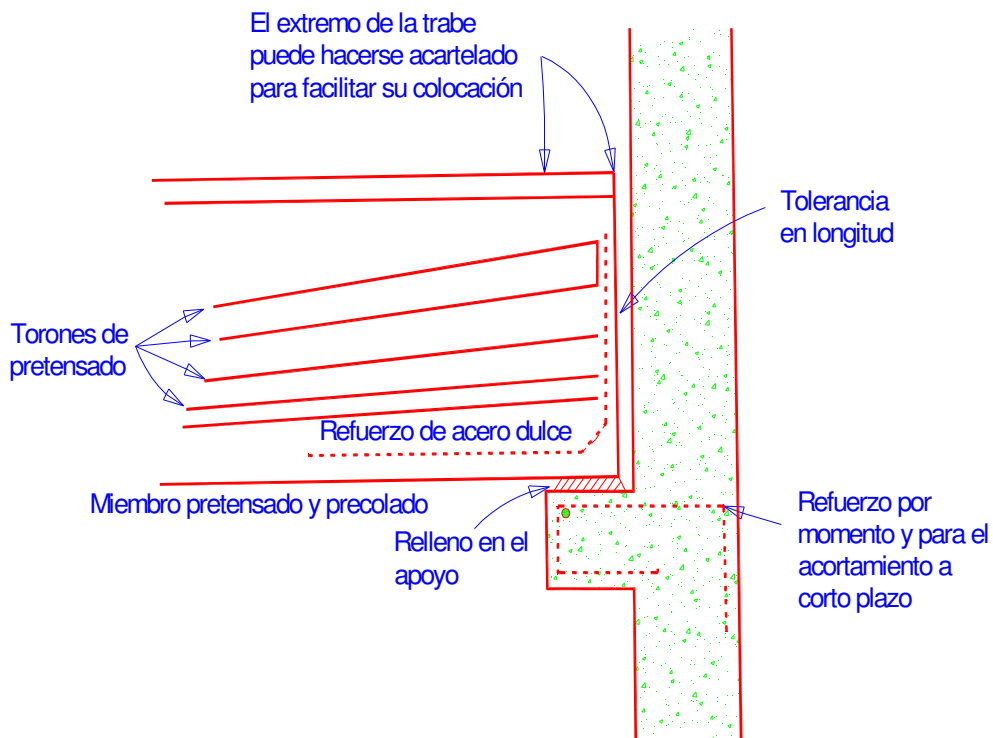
Detalle típico de apoyo; losa o trabe sobre un muro.
